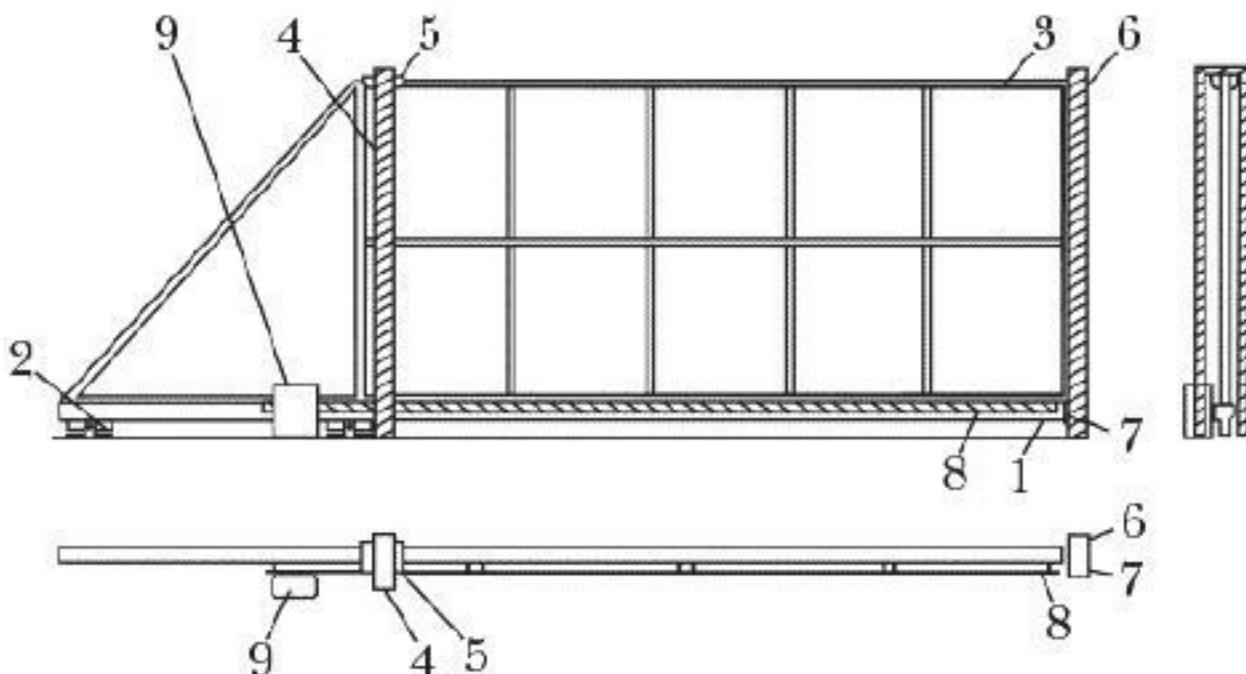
Схема устройства откатных ворот: 1 – несущий профиль; 2 – несущая роликовая тележка; 3 – полотно ворот; 4 – опорный столб; 5 – плато от бокового качения; 6 – ответный столб; 7 – нижний уловитель; 8 – зубчатая рейка; 9 – электропривод
